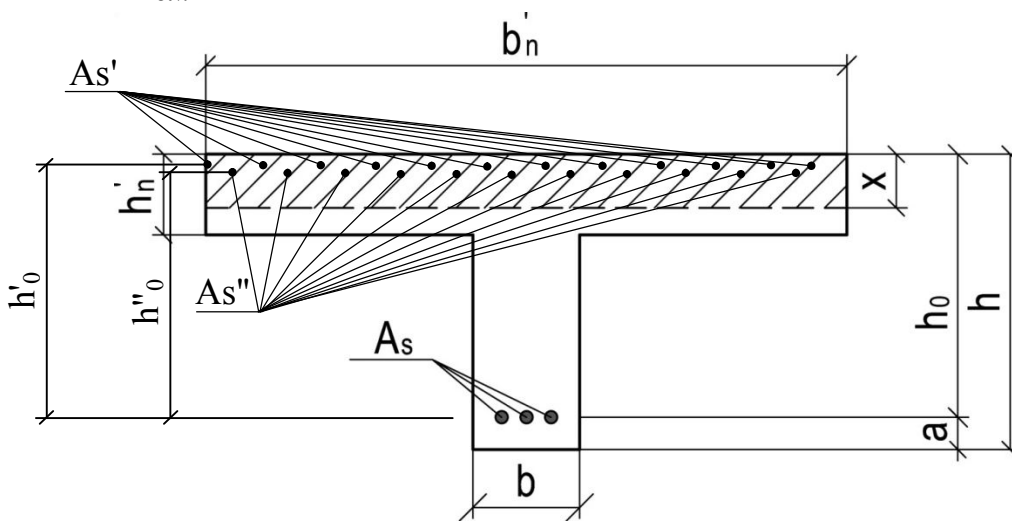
Расчетная схема нормального сечения плиты перекрытия ПТ7-1
